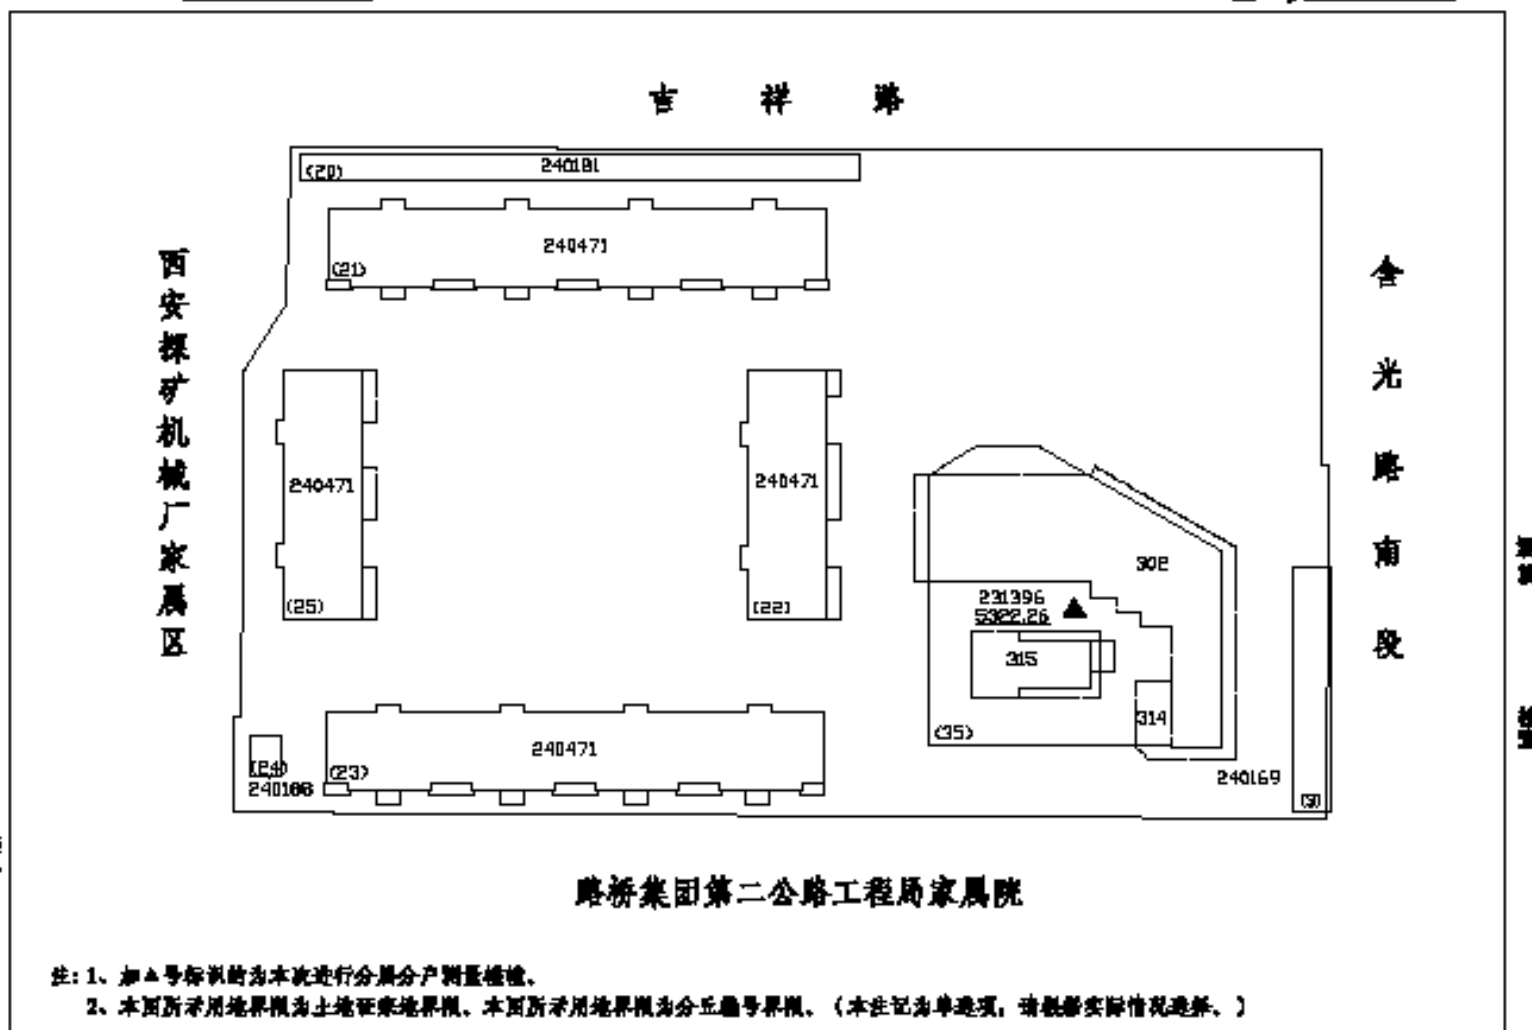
建筑物实测(建筑物实测变更)分户平面图(示例)
